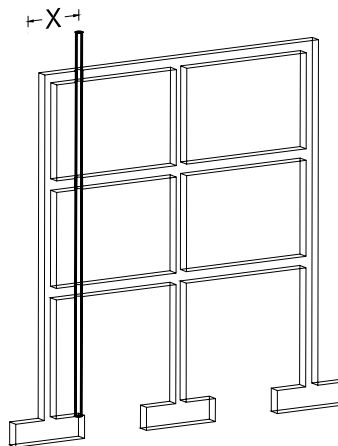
Posiciones de afectación consideradas para bajantes embebidos en vigas de diferentes niveles en un pórtico.
